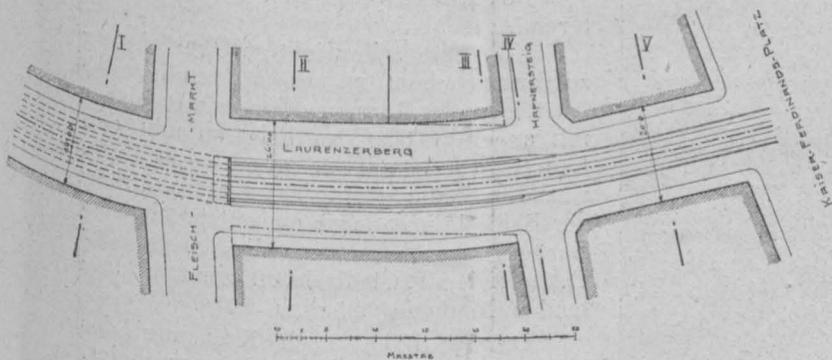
Lageplan des Überganges der Untergrundbahn zur Hochbahn am Laurenzerberg
